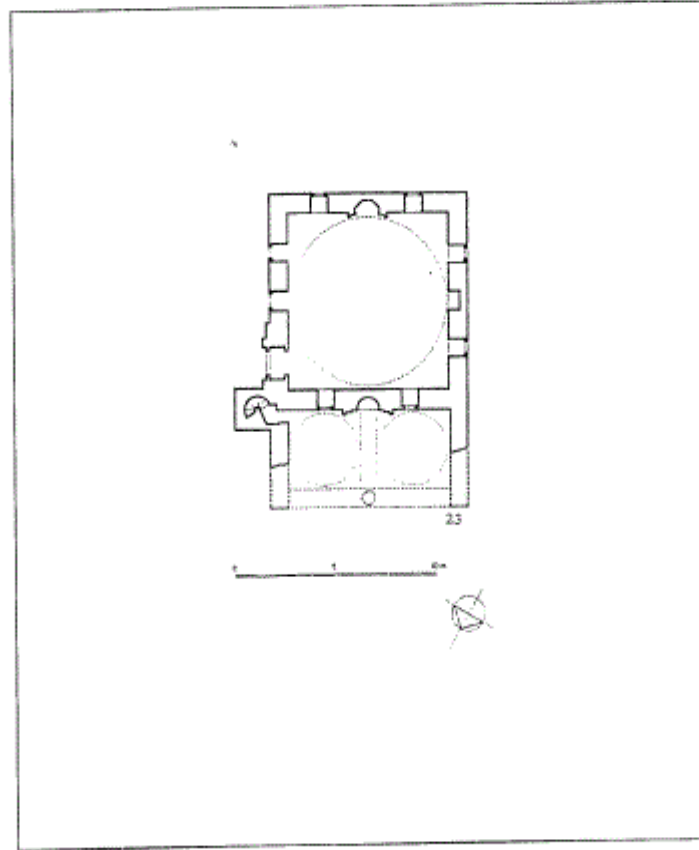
مسقط أفقي لمسجد خداوندكار في توزلا (عن: أيفردى).
